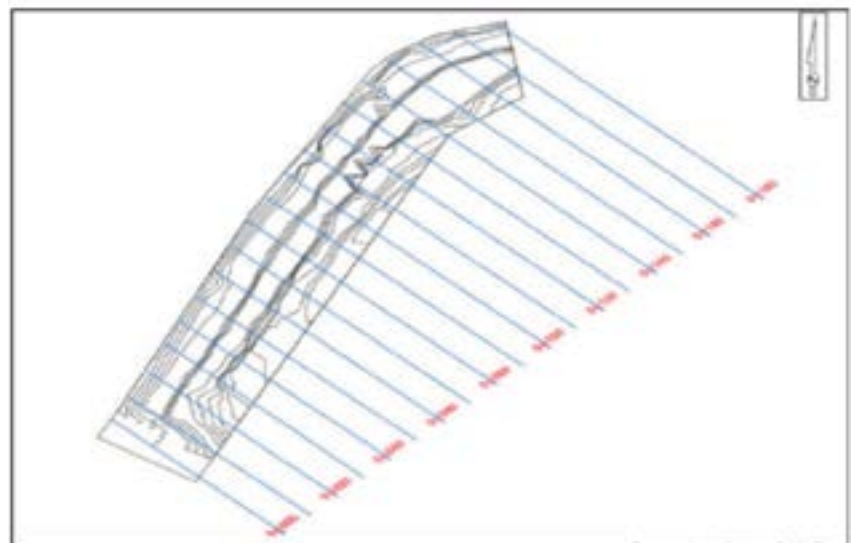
Planta topográfica y ubicación de las secciones utilizadas en la modelación con SLIDE.
